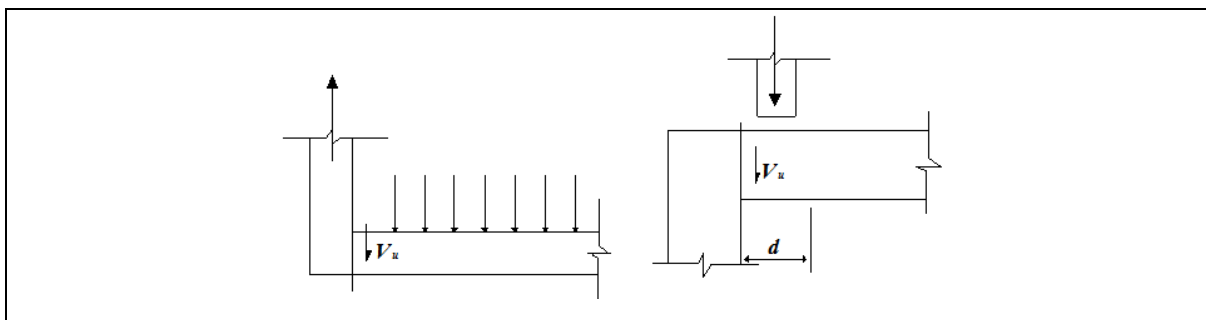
Ubicación fuerza cortante crítica en un elemento de concreto reforzado.
